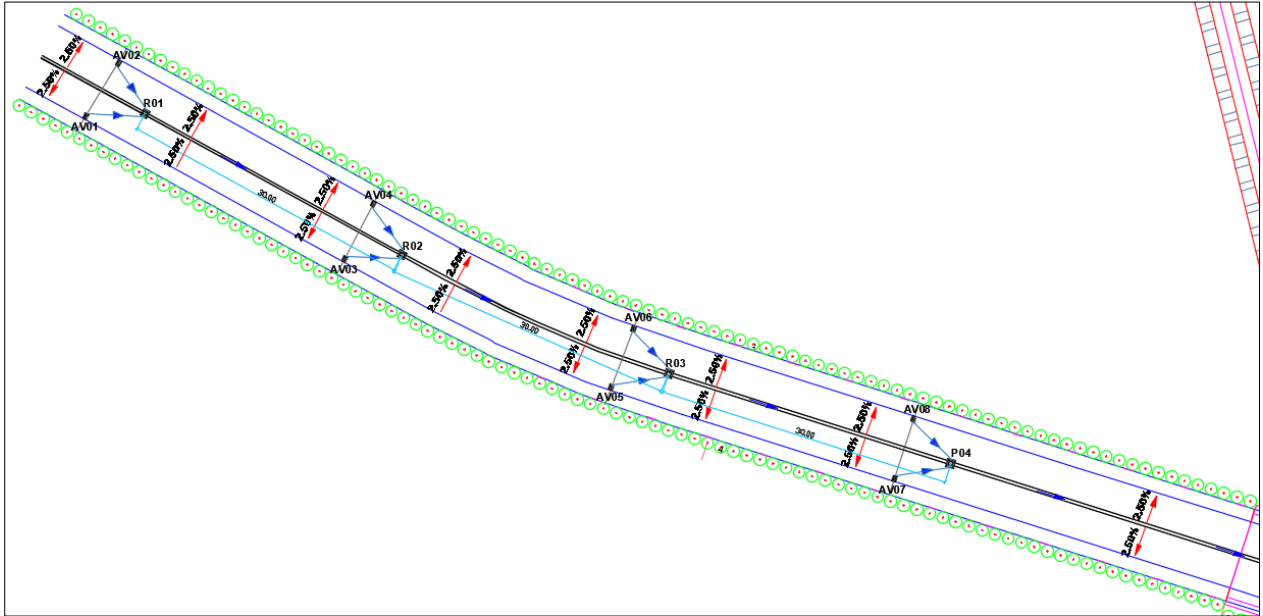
Plan d'assainissement de la partie ouverte – vers Blida –
